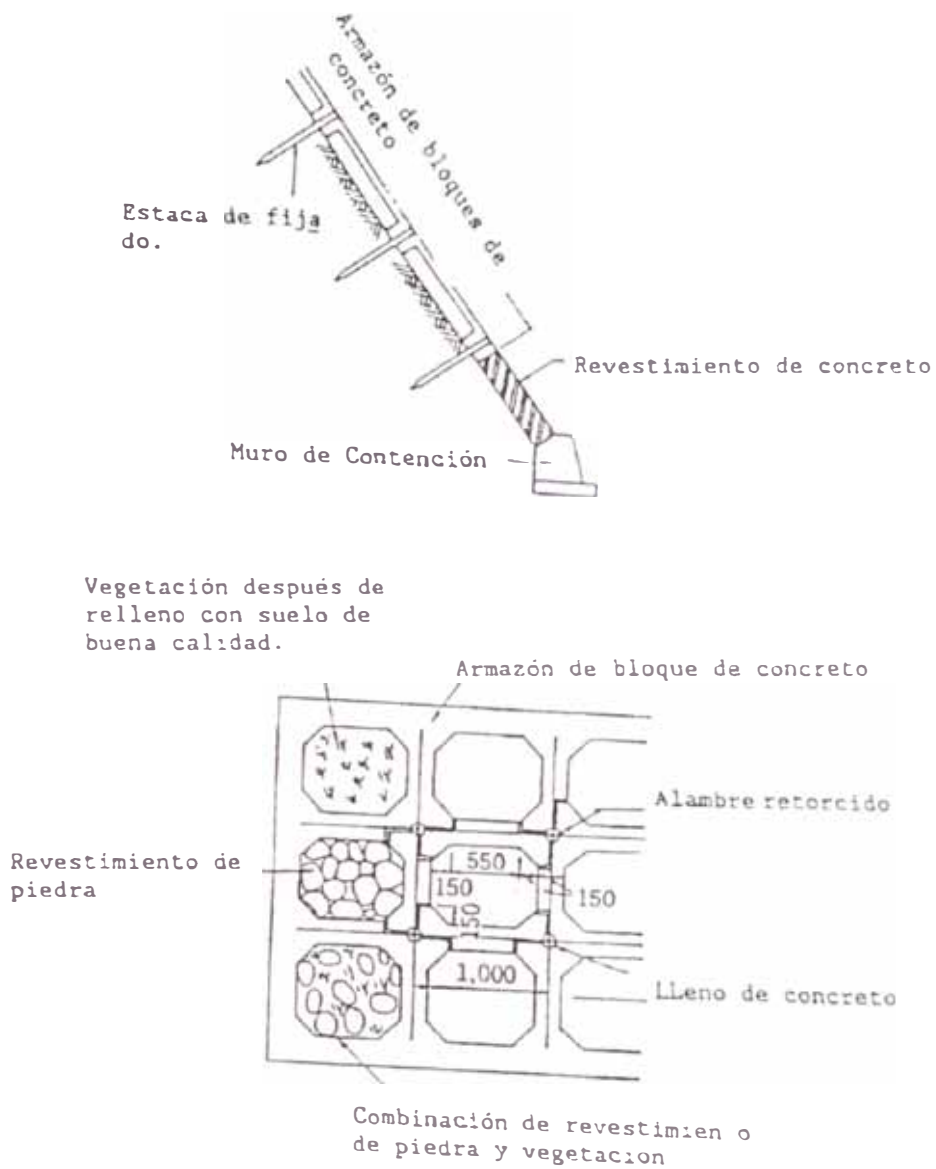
UN EJEMPLO DE ARMAZON DE BLOQUES DE CONCRETO (Unidad: mm)
